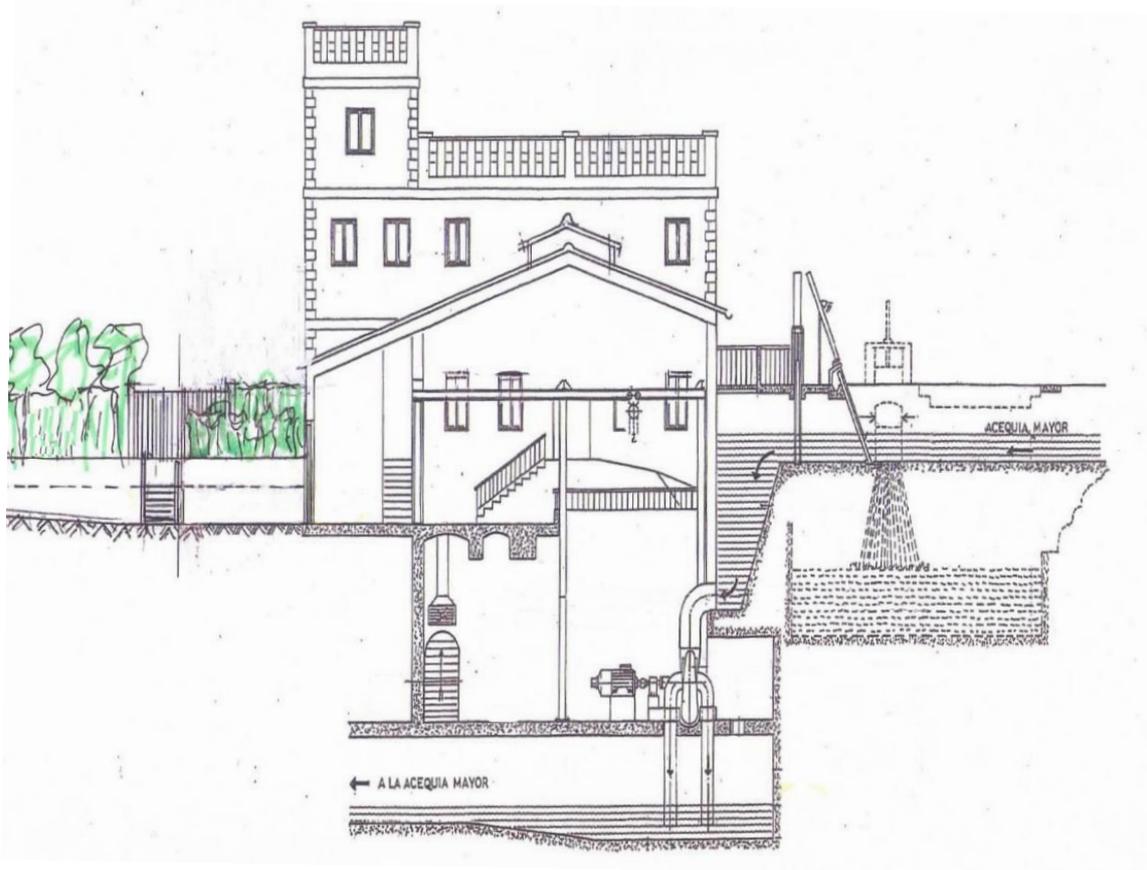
Estructura interna y externa de la vieja central hidráulica.
